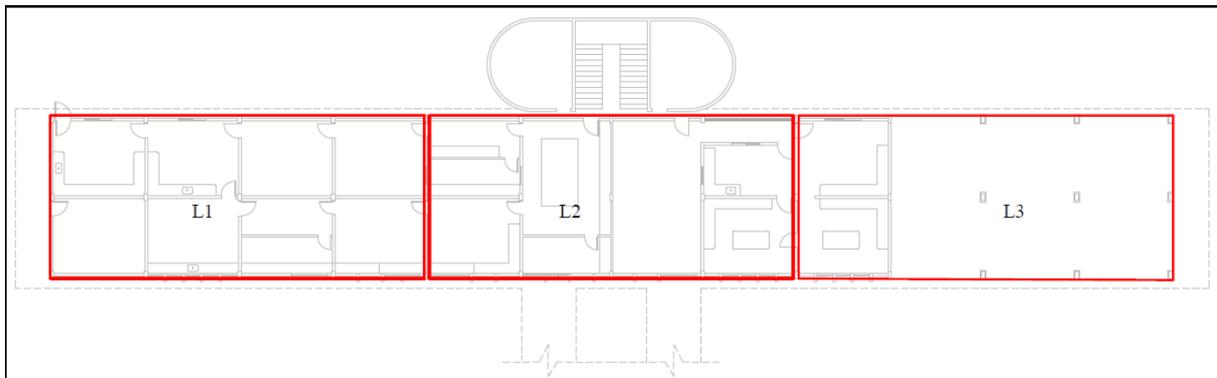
Distribuição das lajes do 1º pavimento. (Secretaria de Infraestrutura, UFRSA)
